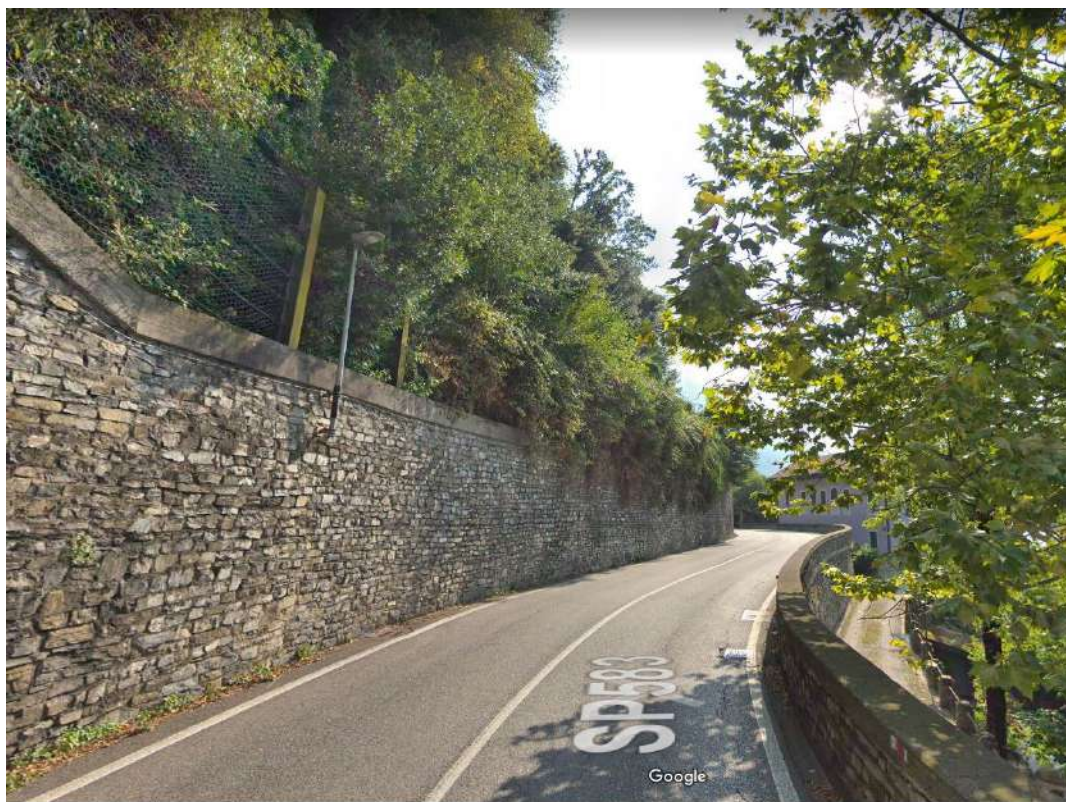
e 2 . Vegetazione vista dalla strada SP583. Vista del muro di contenimento e della roccia a formare una rupe verticale.
